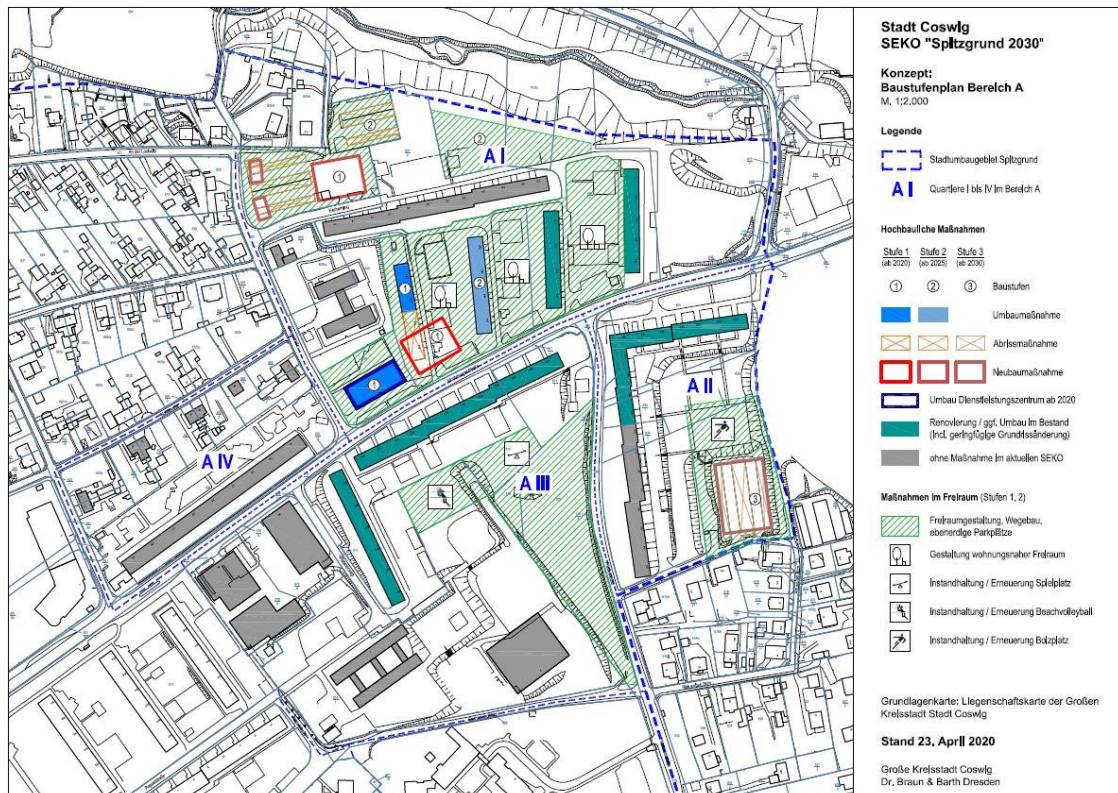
Baustufenplan Spitzgrund - Planungsbereich A<sup>293</sup>
